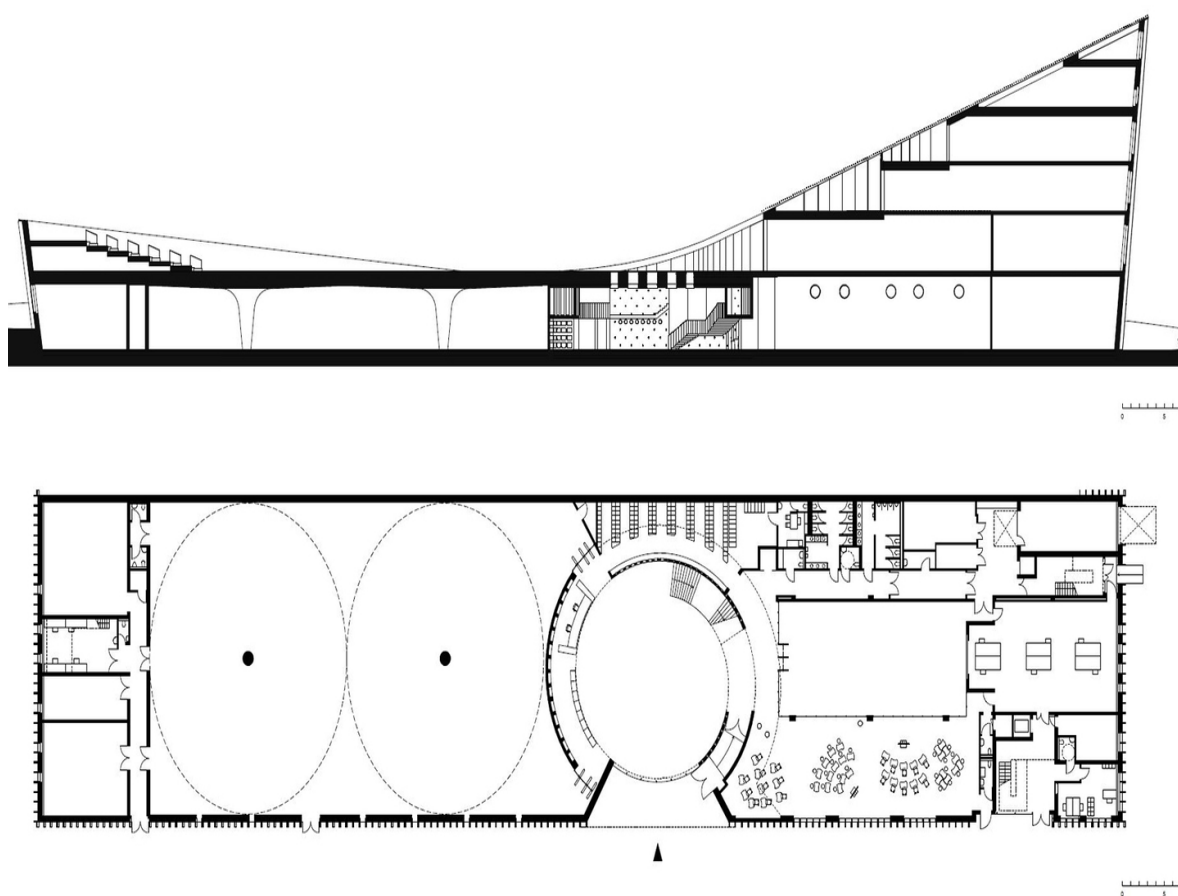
Centro de Ciência e Inovação Vizium, corte longitudinal, planta piso térreo.
